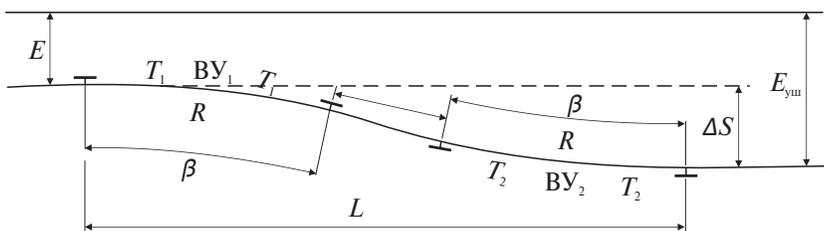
Расчетная схема параллельного смещения главного железнодорожного пути без переходных кривых
